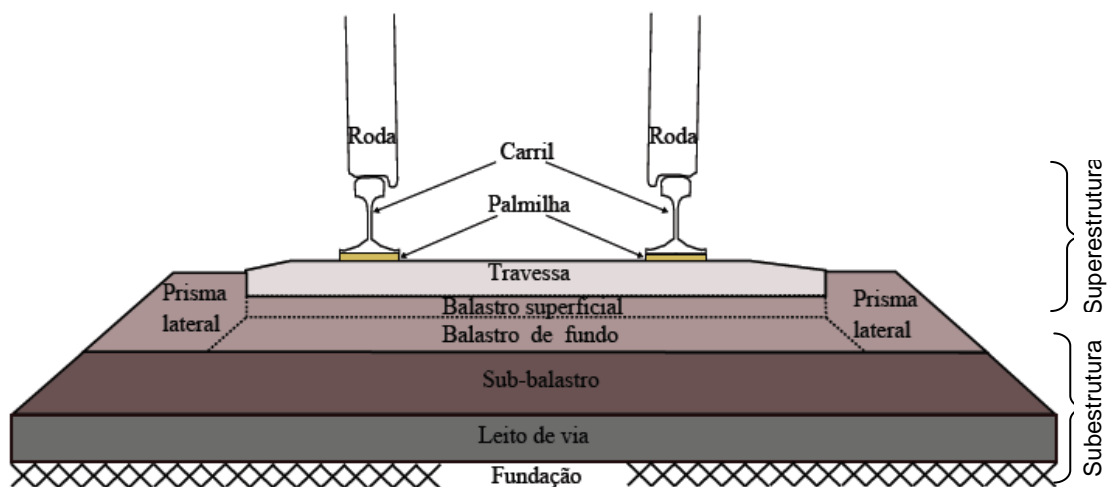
Esquema estrutural da via ferroviária balastrada clássica: secção transversal, adaptado (Vale, 2010).
